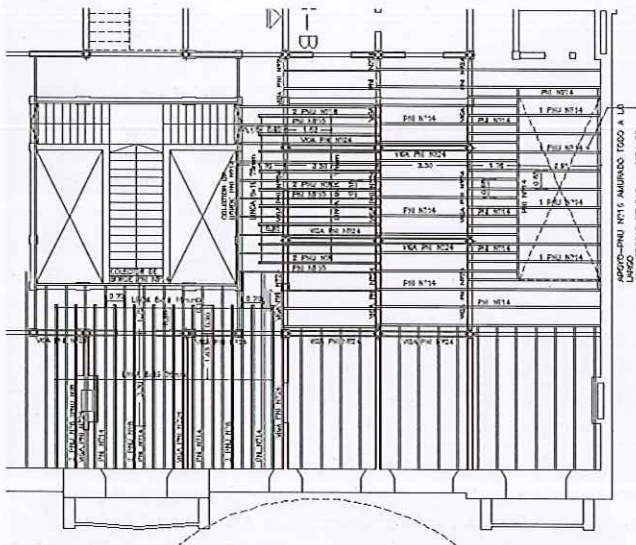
y 13 - Esquema de refuerzo estructural - colocación de perfiles intermedios
